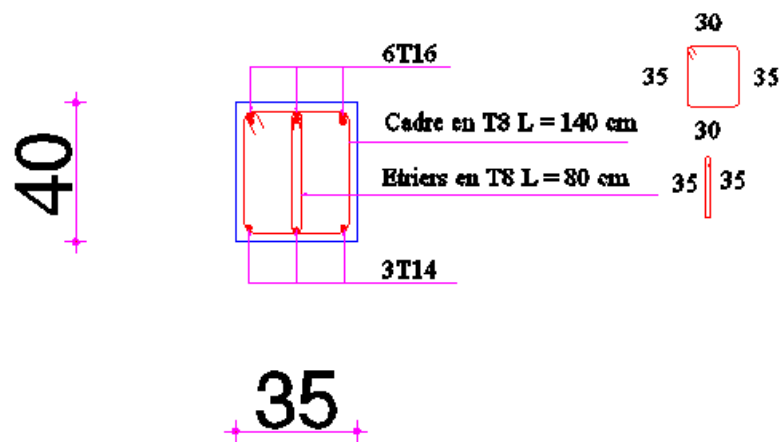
ferrailages des poutres principales sur appuis (35x40)
